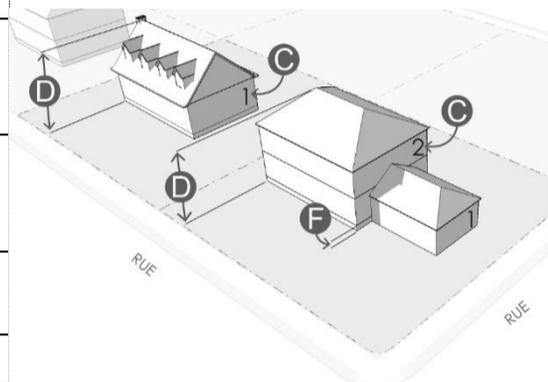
Hauteur d'un bâtiment et du plancher du rez-de-chaussée
